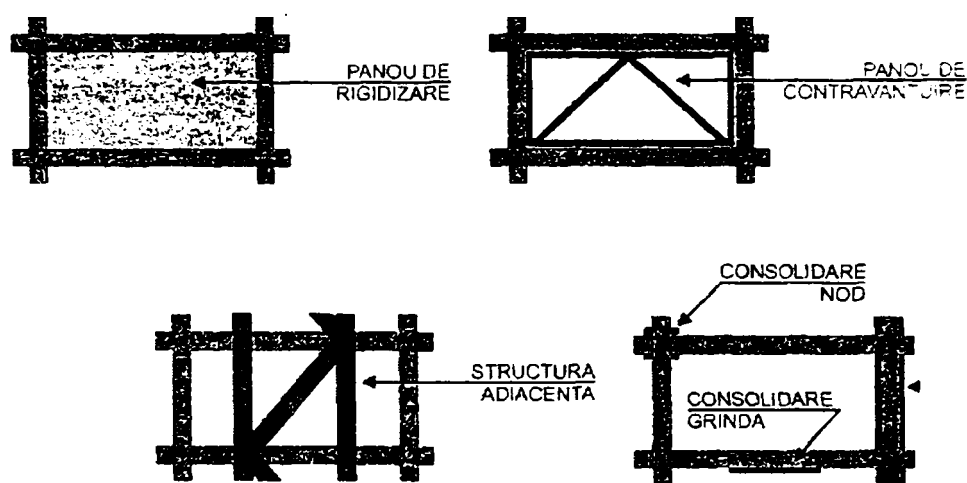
Metode de consolidare a structurilor in cadre din beton armat.
